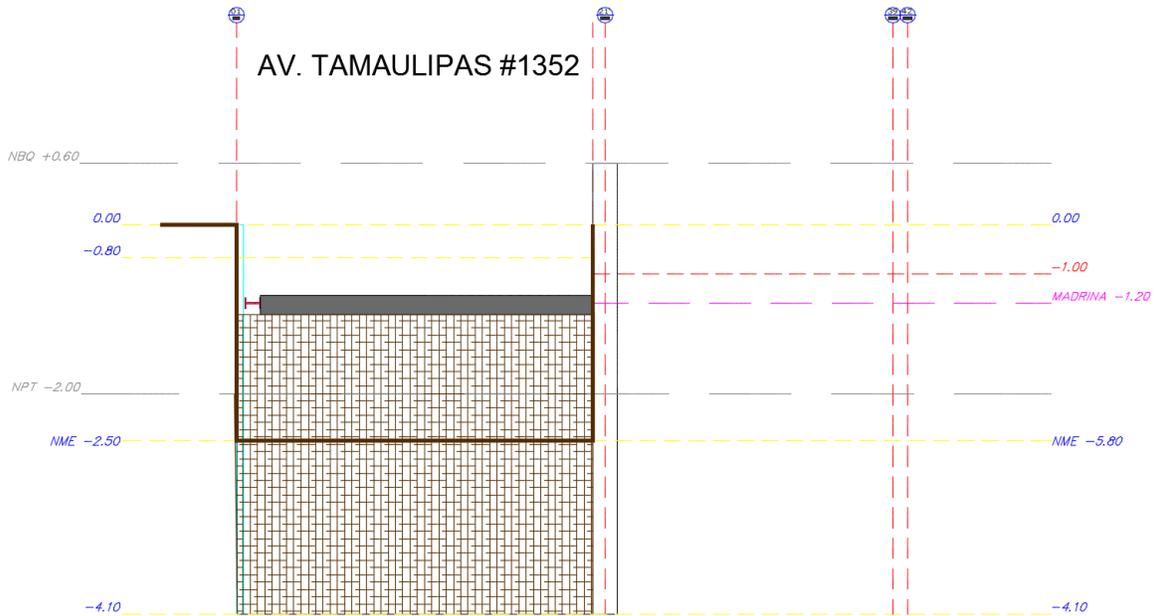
PRIMER NIVEL DE TROQUELES.
